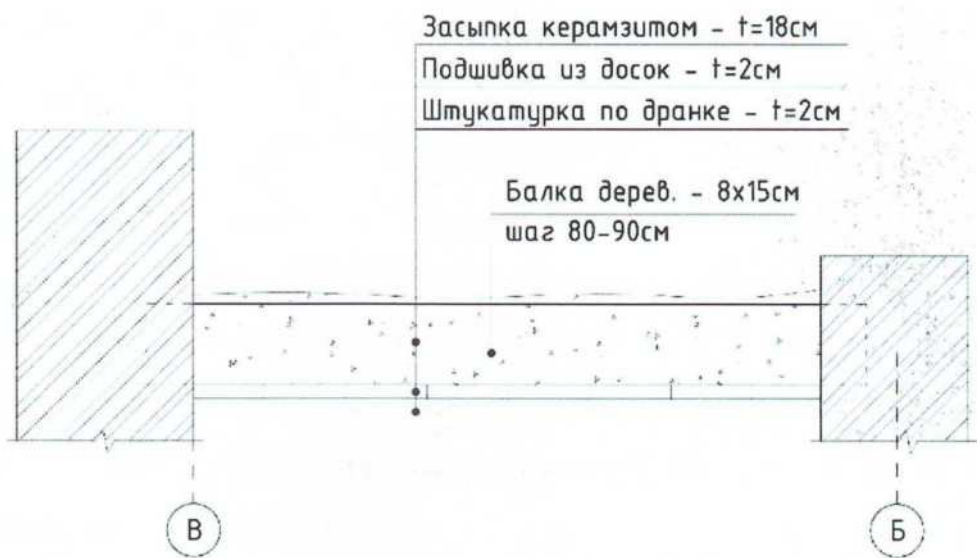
Конструктивное решение перекрытия 2-го этажа в месте вскрытия №5
